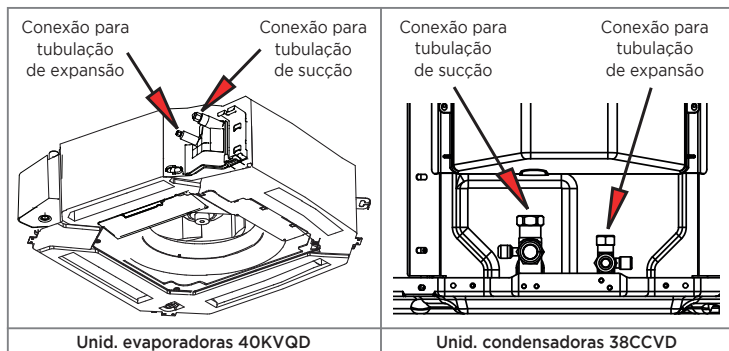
CONEXÕES DE INTERLIGAÇÃO
